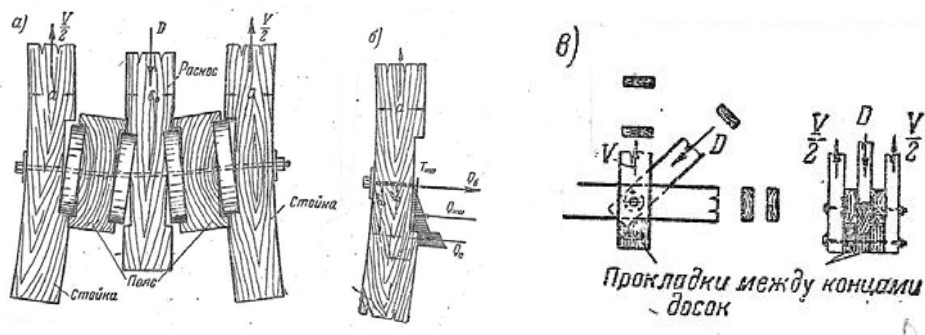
Узел нижнего пояса фермы на кольцевых шпонках
